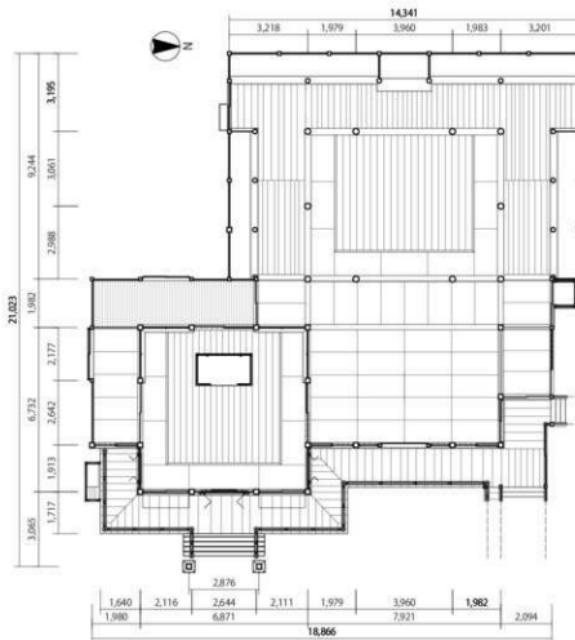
金剛三昧院本堂及び位牌堂平面図 1:200
